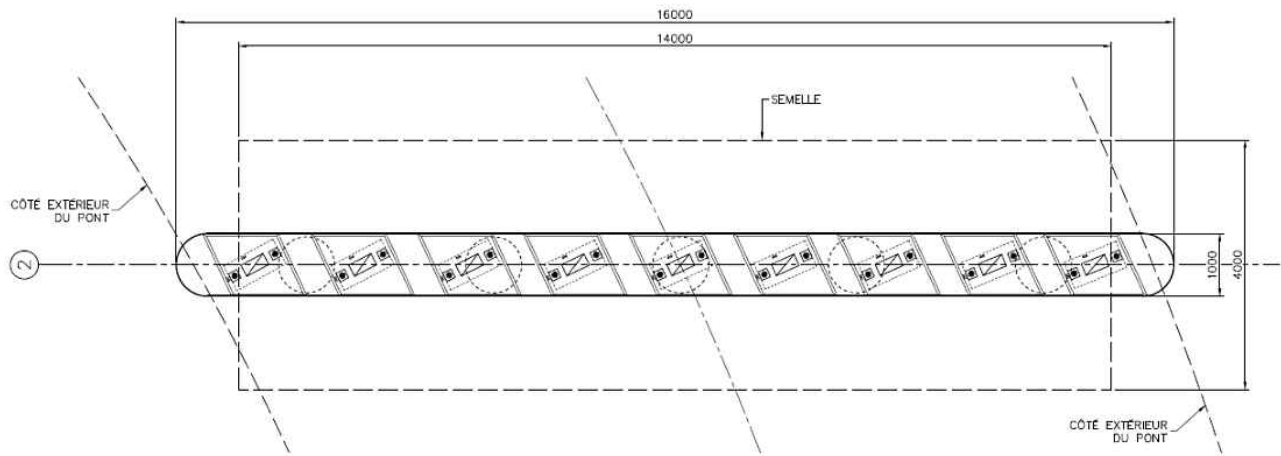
Pont d'étagement routier – Pile axe 2 – Variante B - Vue en plan
